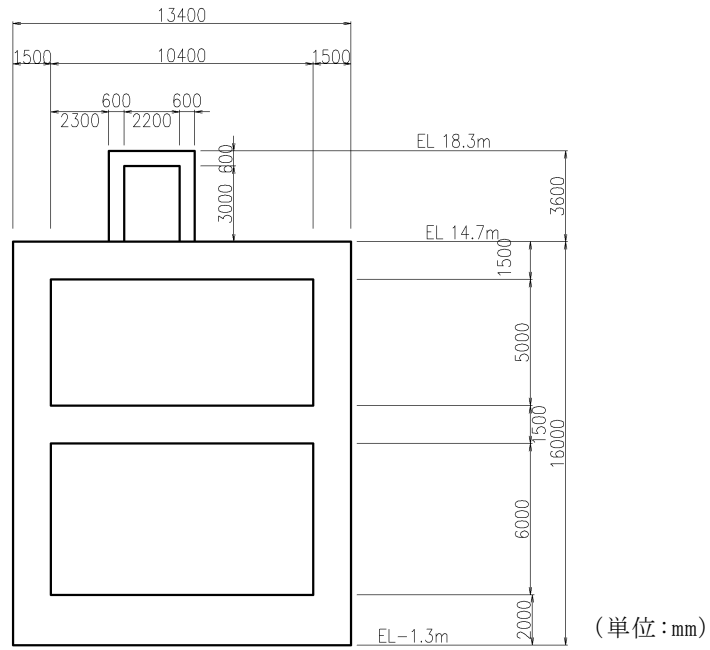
低圧原子炉代替注水ポンプ格納槽 断面図 (A-A断面)
